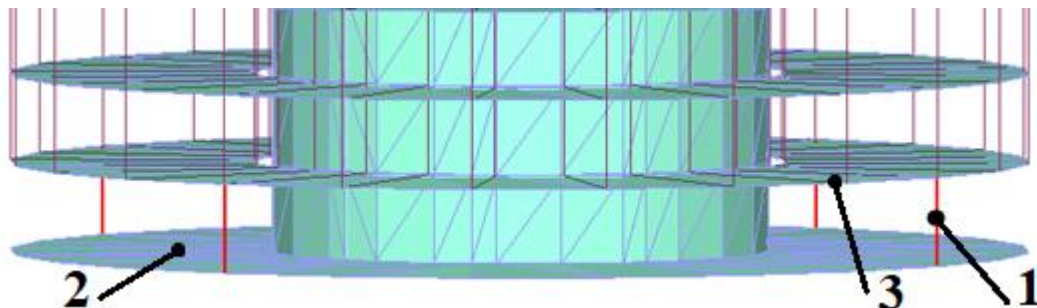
Фрагмент расчётной модели: 1 – предварительно напряжённые ванты; 2 – фундамент; 3 – подвешенное перекрытие
